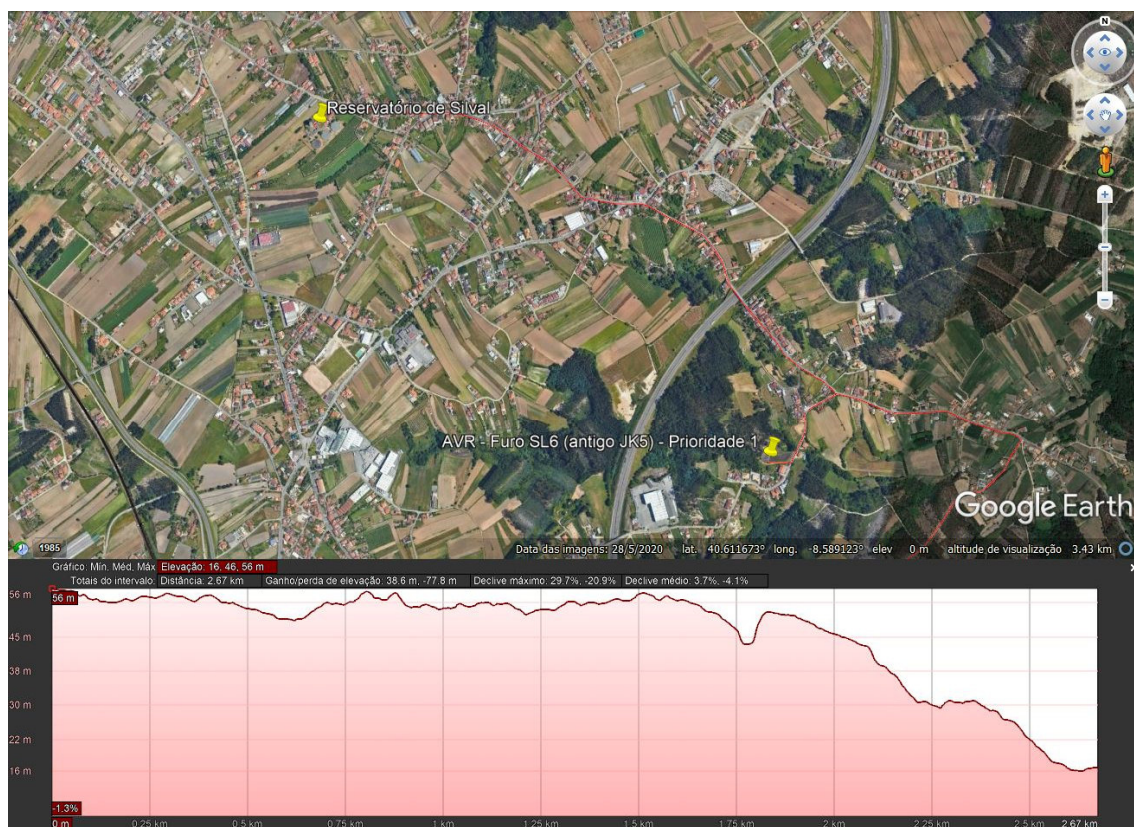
Planta e perfil longitudinal da conduta adutora Furo SL6 – reservatório de Silval (Google Earth)
